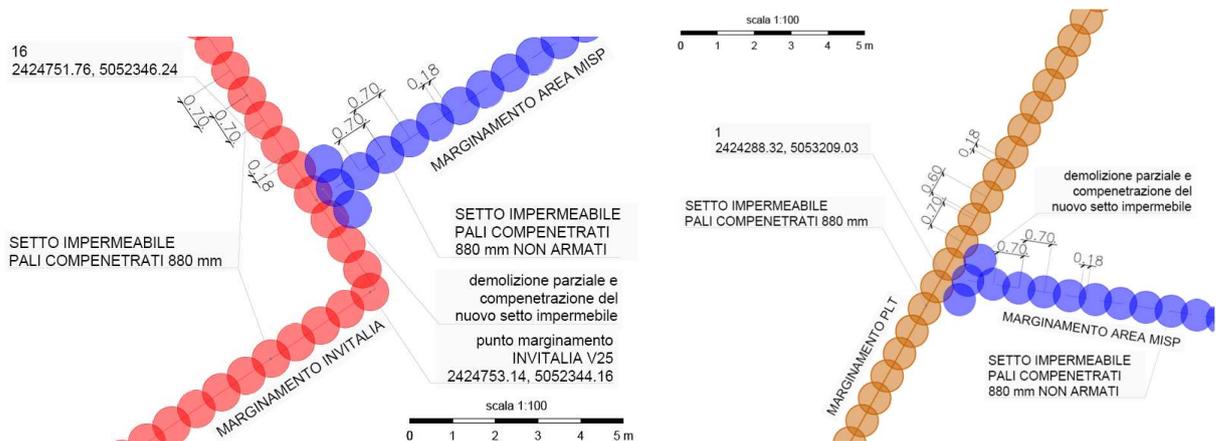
Estratto tavola G.01.L.010 - planimetria setto impermeabile (a sinistra collegamento con diaframma Invitalia, a destra quello con diaframma PLT)
